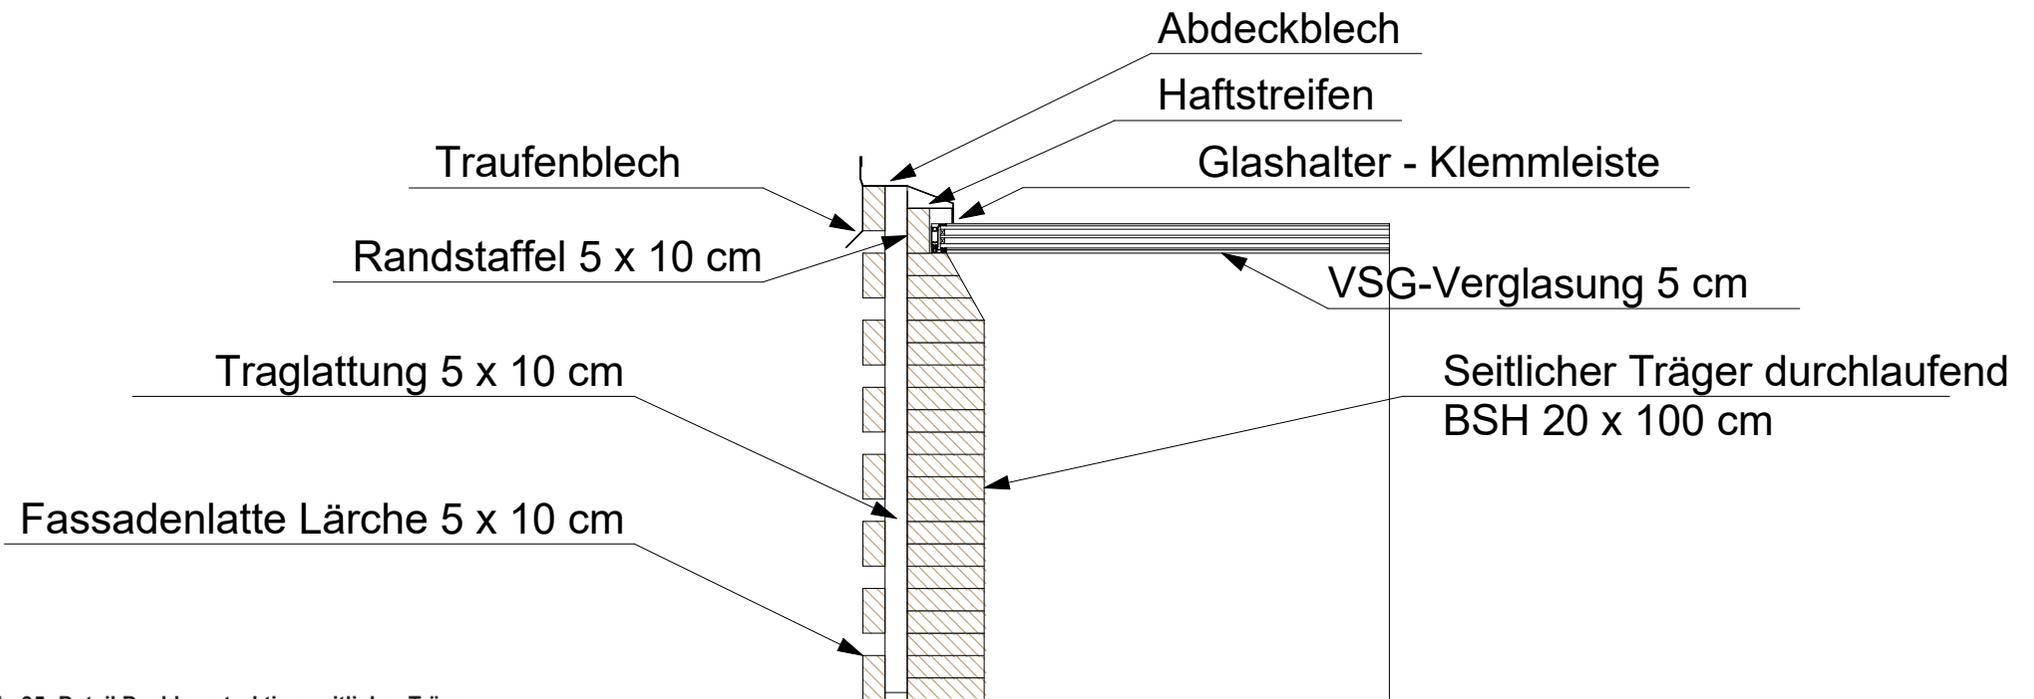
Detail Dachkonstruktion seitlicher Träger
